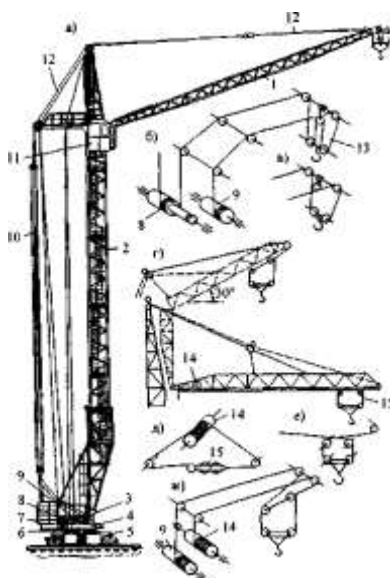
Башенный кран с поворотной башней.
